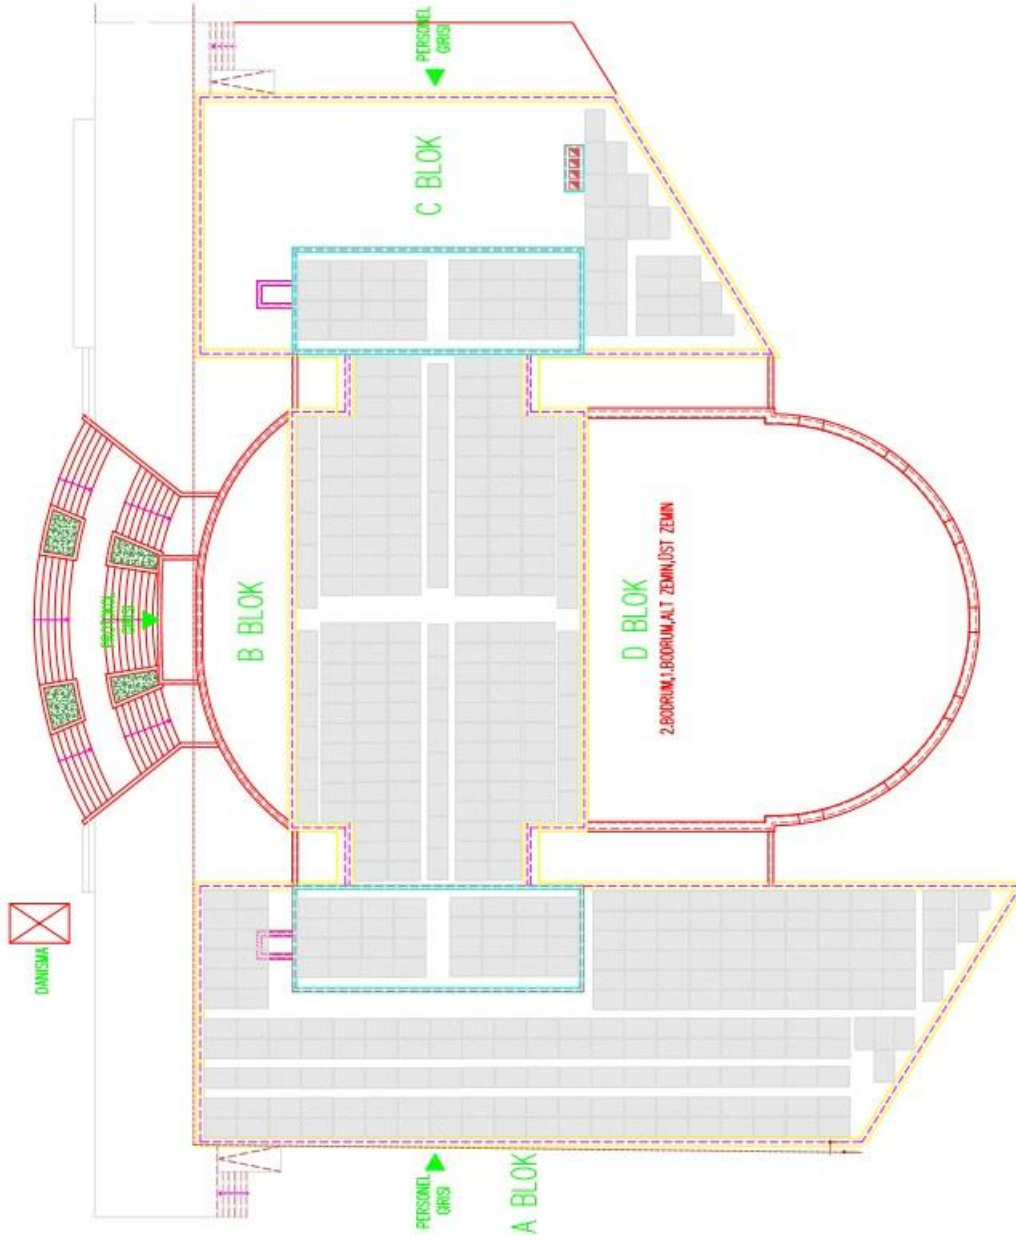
Bina geneli fotovoltaik panel yerleşim planı
